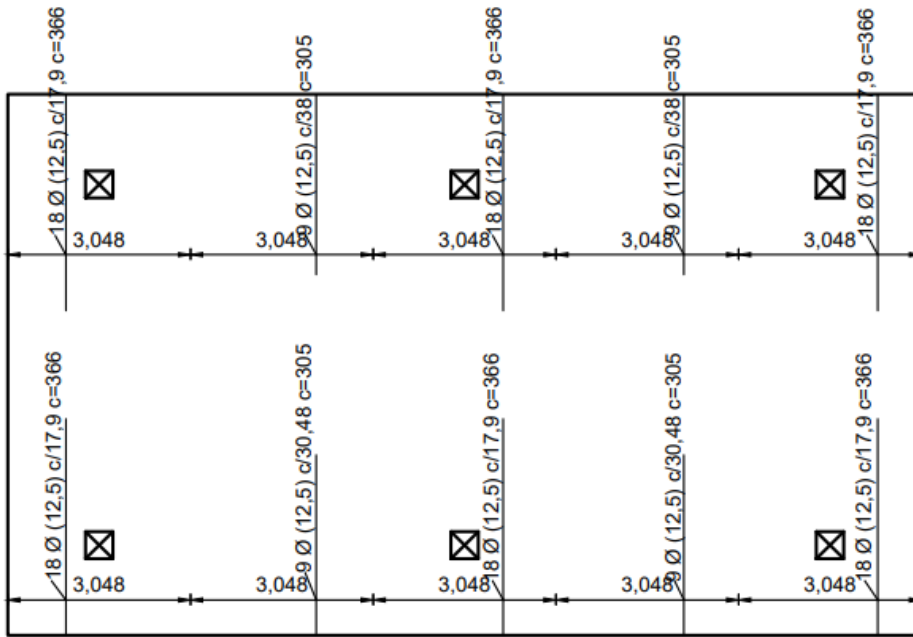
Armadura transversal superior. Adaptado de Fick (2008).
